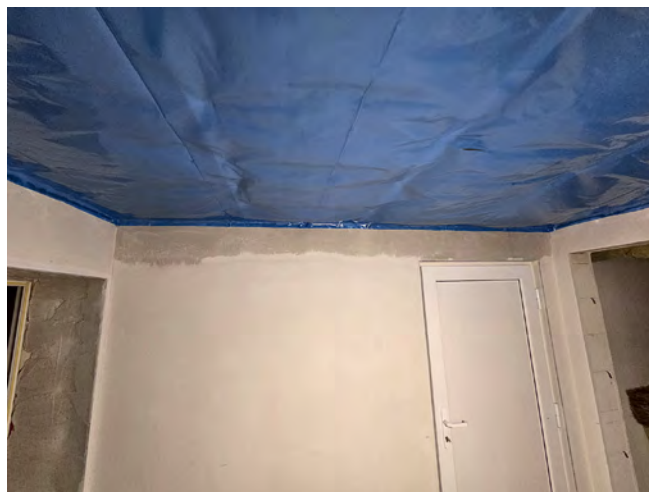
Übersicht des untersuchten Garagenanbaus mit beheizten Nebenräumen und Flachdachkonstruktion
